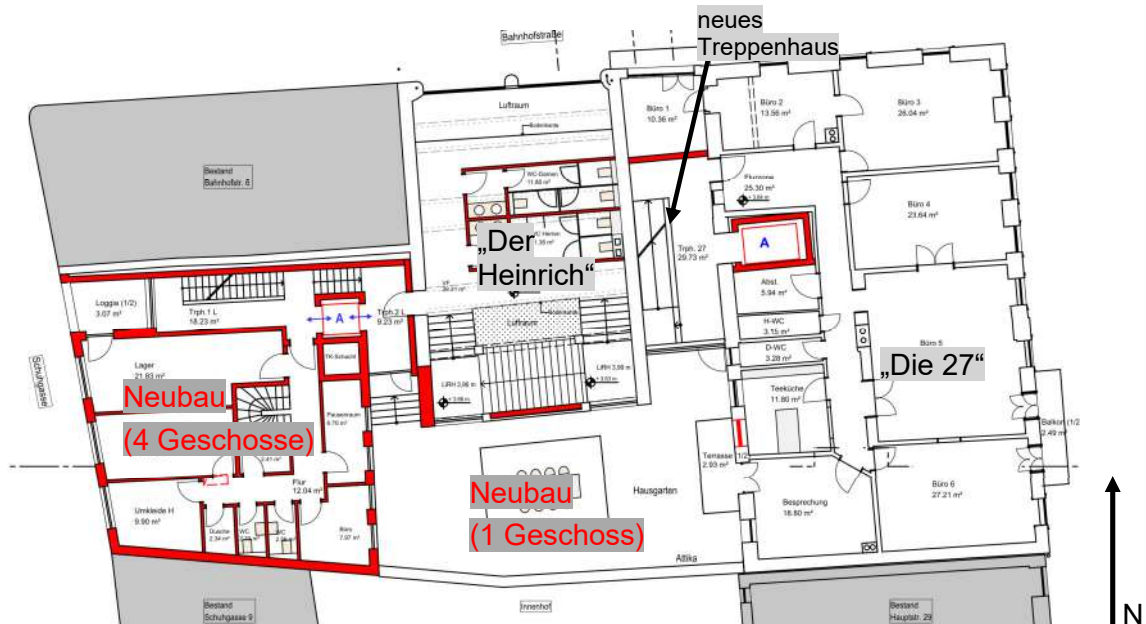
Planung, Grundriss 1.OG (U2.15, ergänzt)
